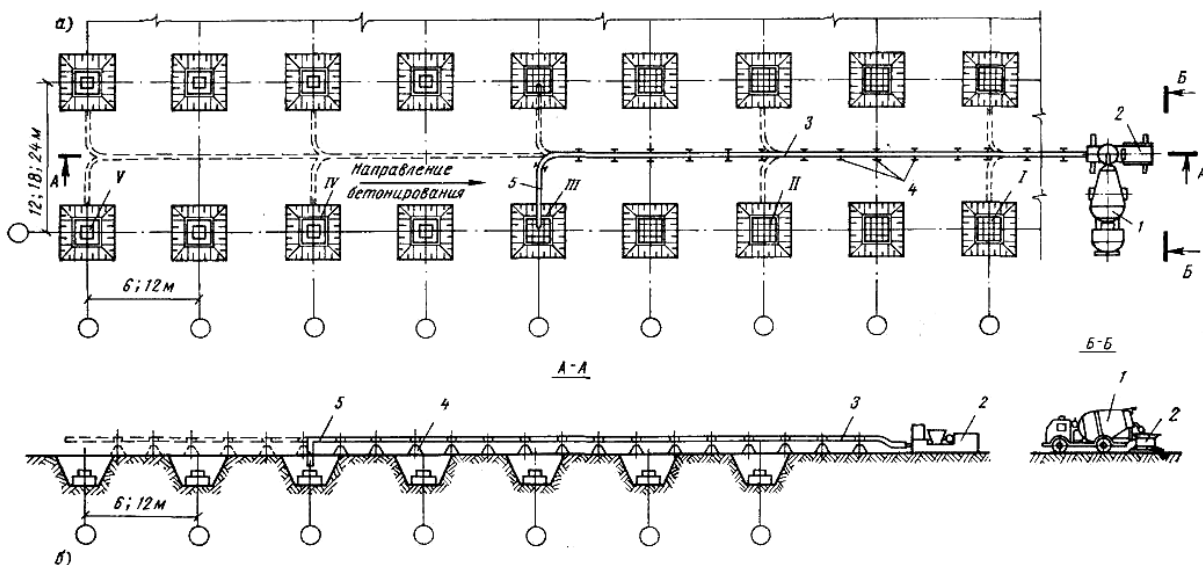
Схема технологічного процесу пристрою монолітних залізобетонних фундаментів - бетононасосами
